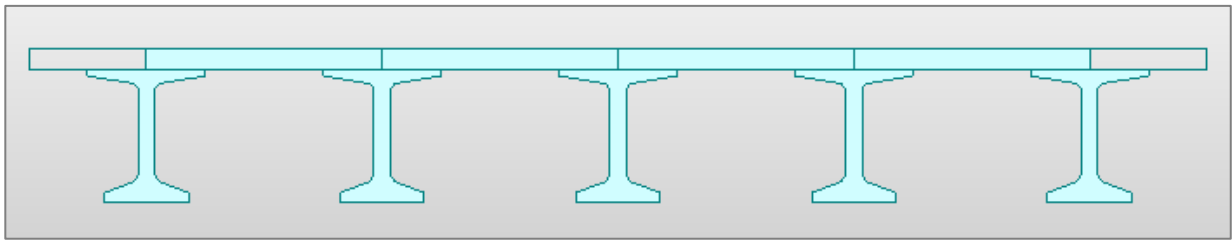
Sección transversal del modelo del puente de vigas con sección doble T de 25 metros de luz central.
